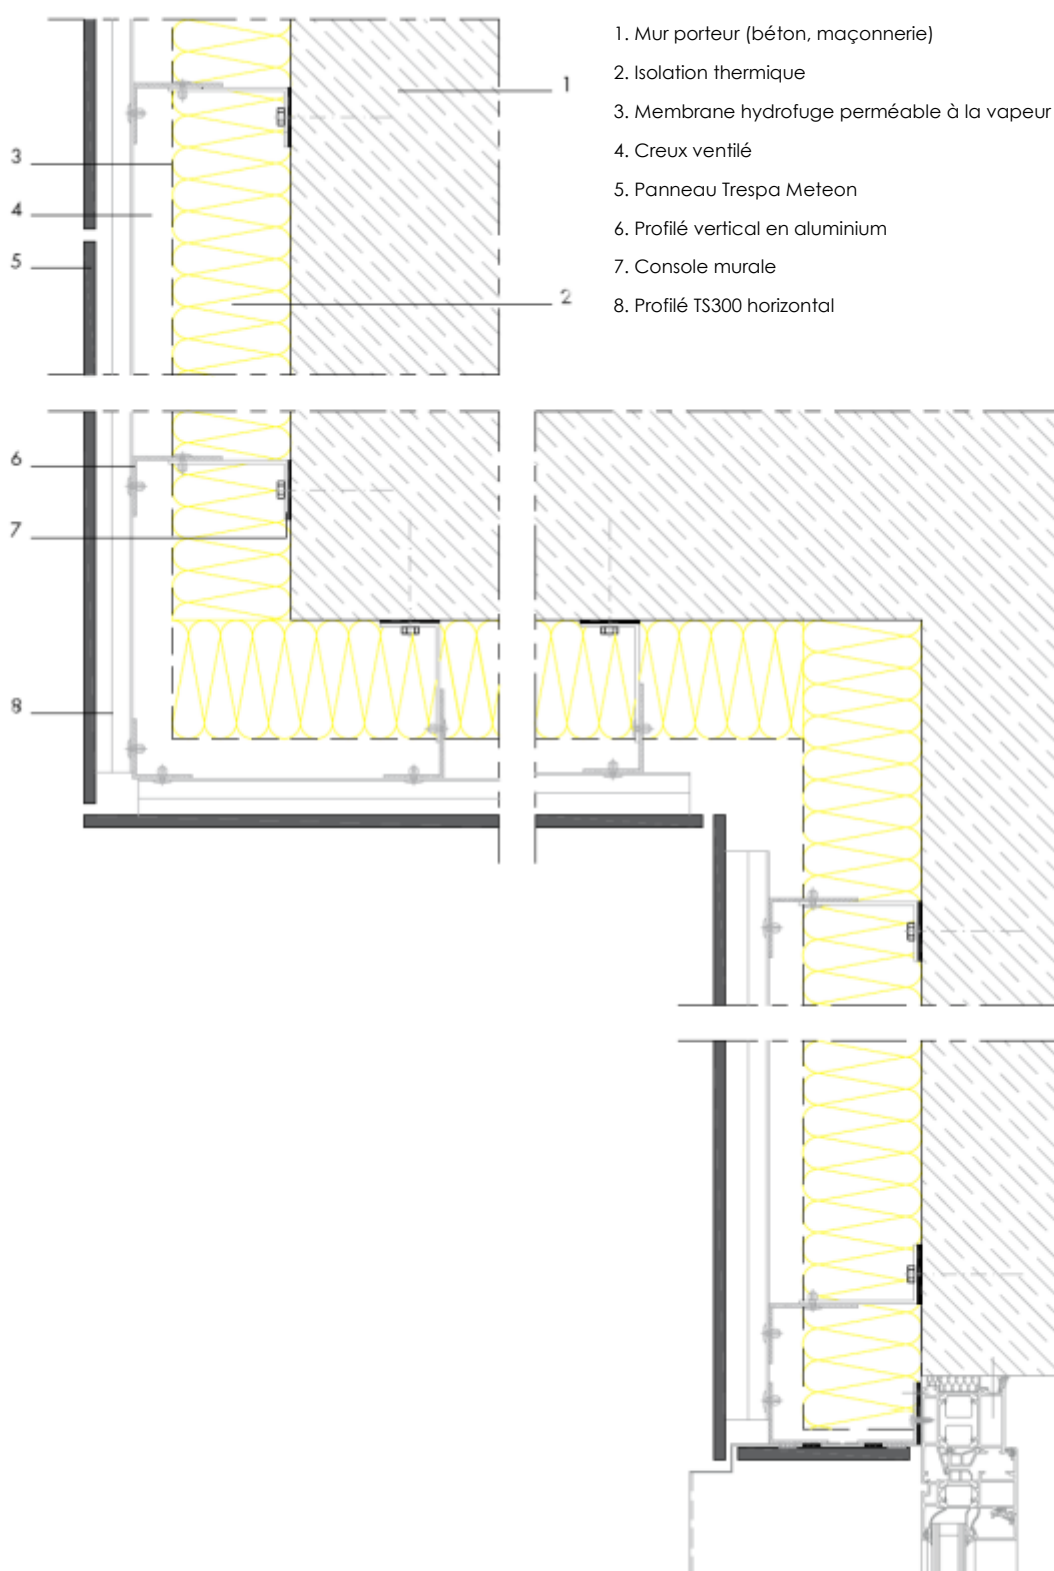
Coupe verticale de la fixation de panneau par système modulaire (bords profilés)
